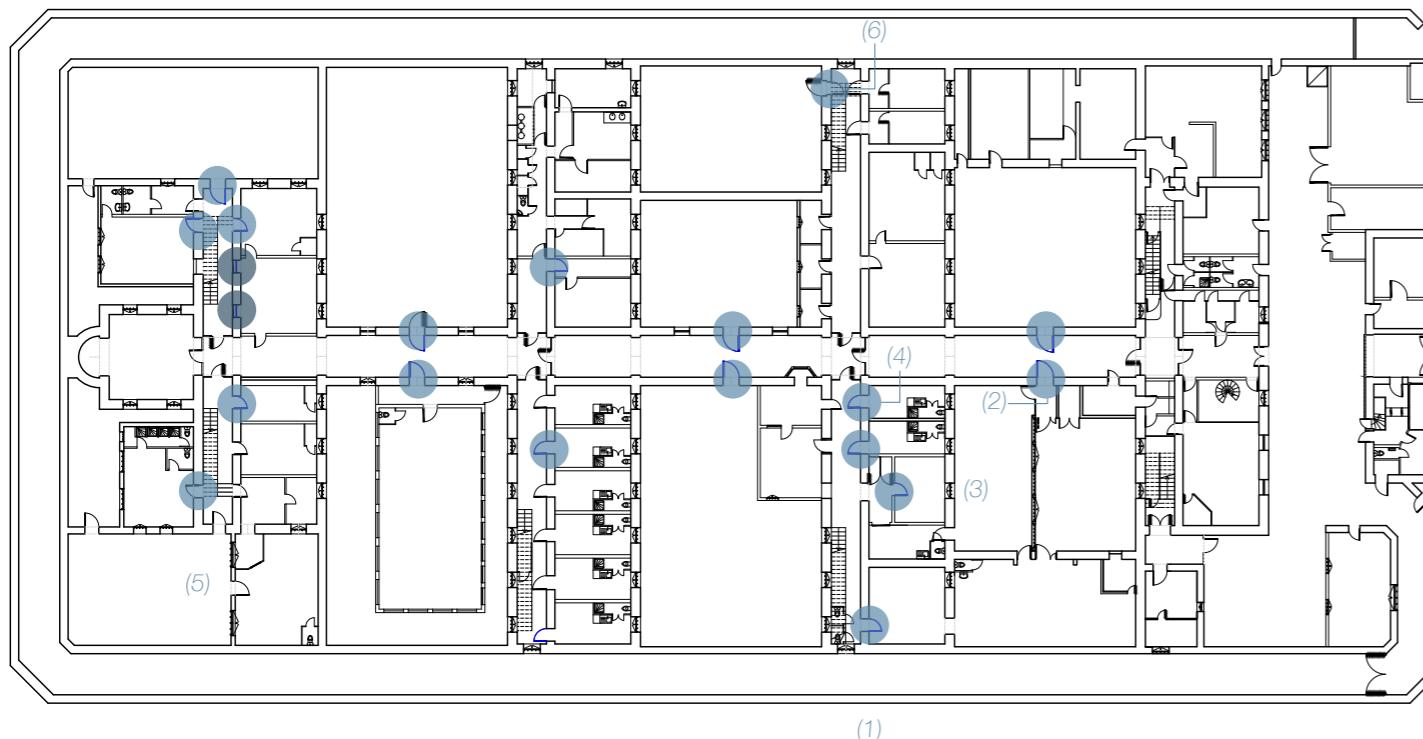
Plan de Rdc : repérage des anciennes portes de la maison d'arrêt. Source : Croisée d'archi.
